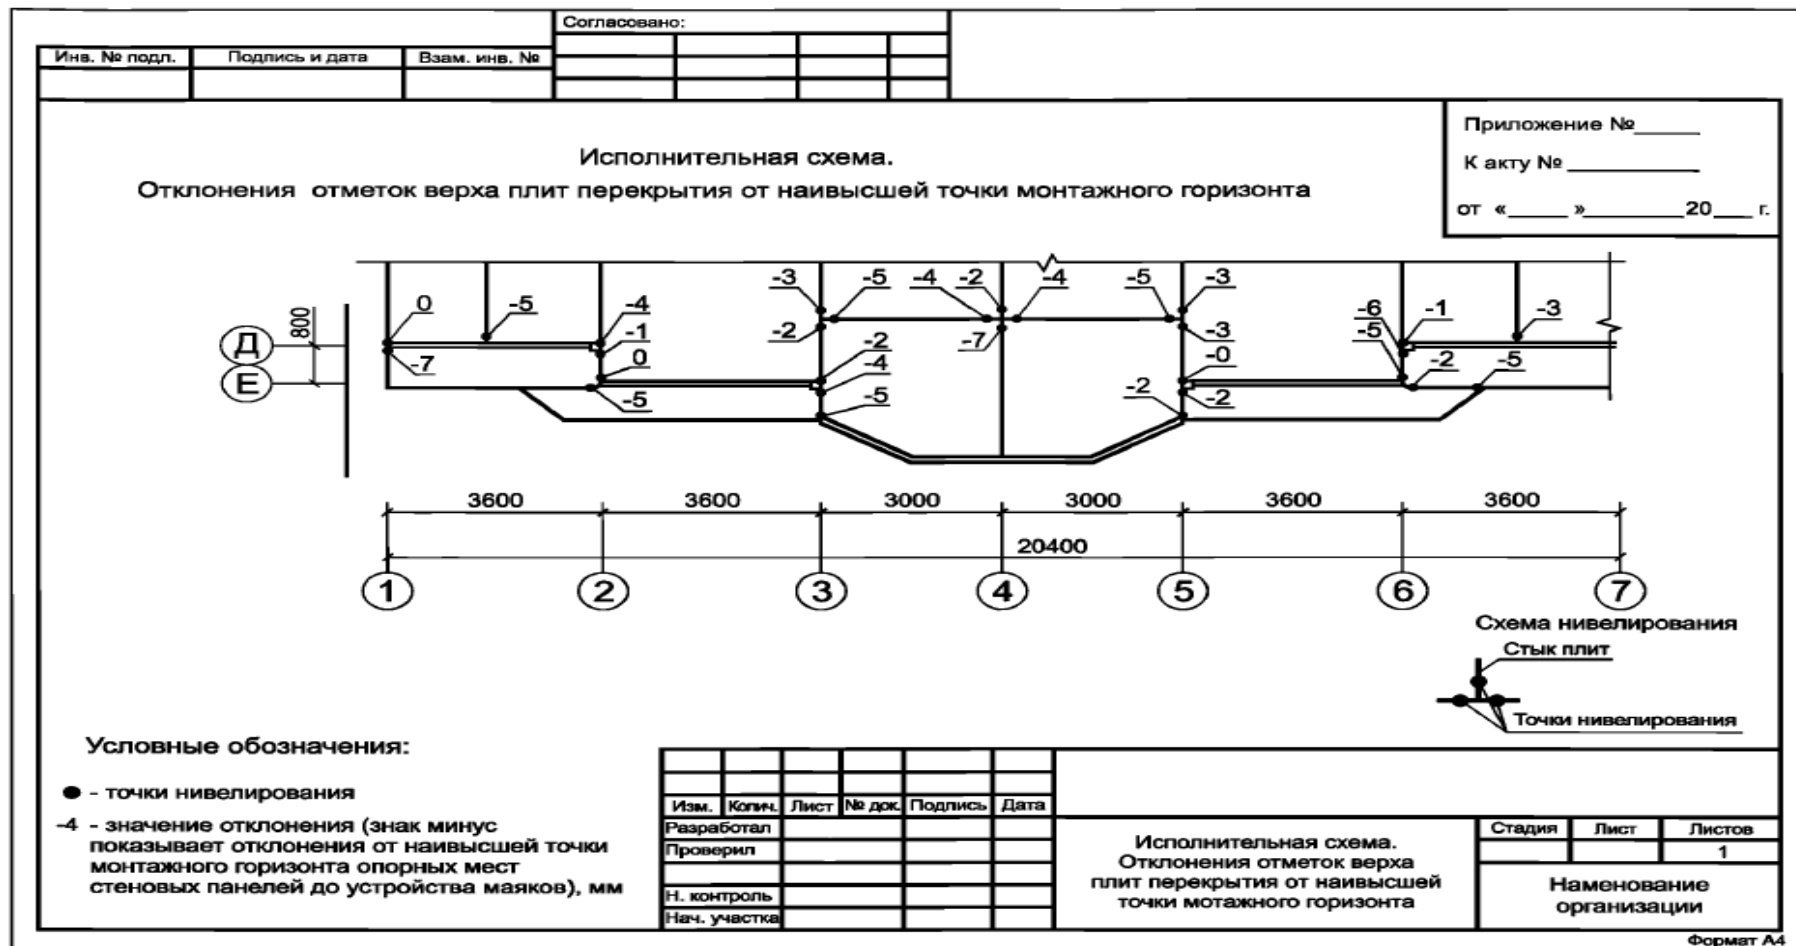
Исполнительная геодезическая схема. Высотное положение этажа жилого дома
